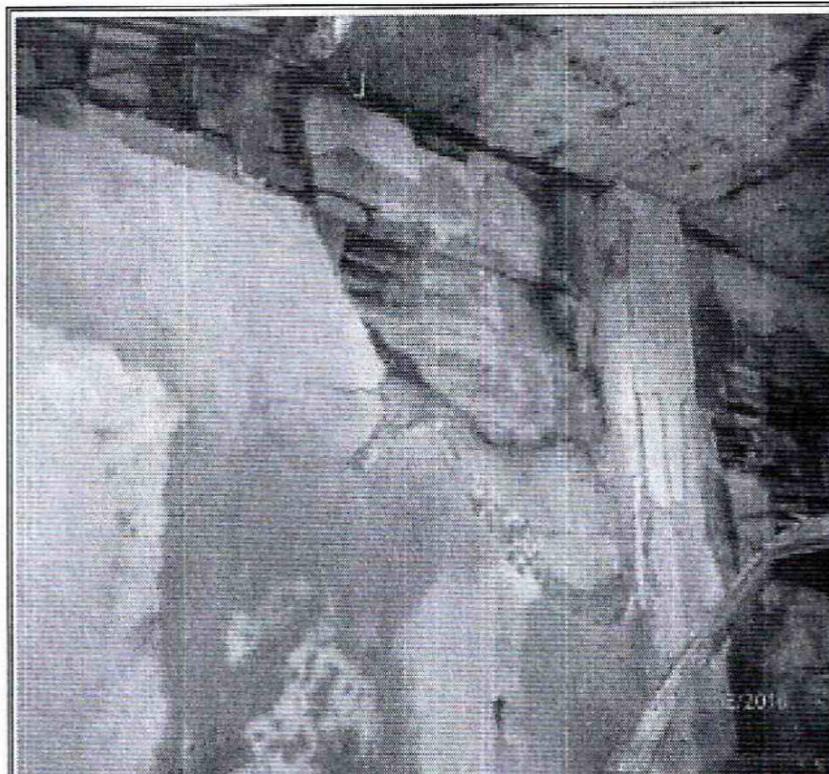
Desprendimiento pañete y afectación mampostería muros de cerramiento perimetral
